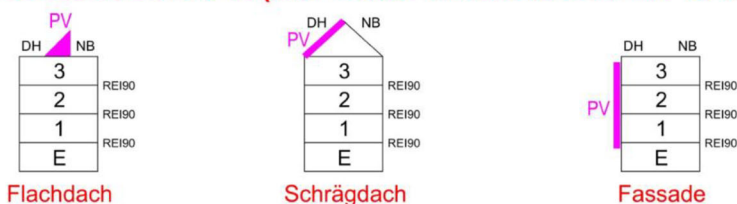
Mögliche Darstellung einer PV-Anlage im Brandschutzplan gemäß Anhang 13 der TRVB 121 O (BF Wien)
